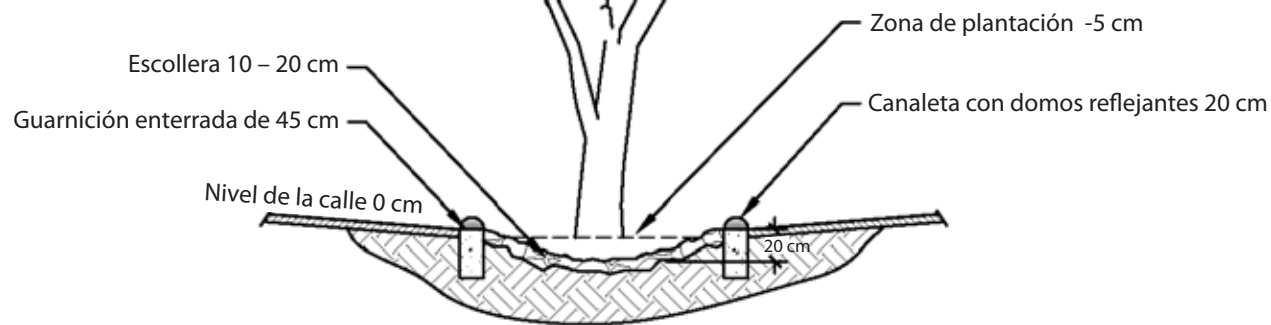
Sección E. Muestra de un camellón con canaletas al ras y zona deprimida de bioretención. Para la vista del plan, vea el Apéndice.
